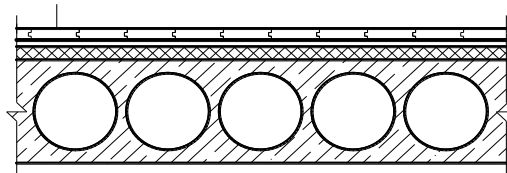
Поперечний переріз конструктивного вирішення збірної залізобетонної круглопустотної плити перекриття
